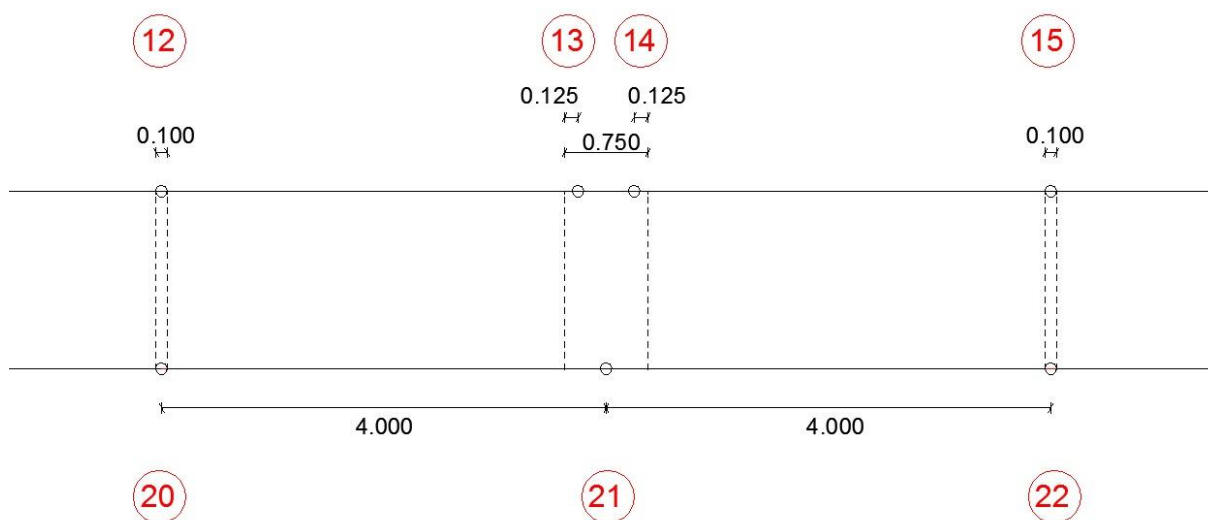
Esquema da zona central de amarração dos cabos (dimensões em metros).
